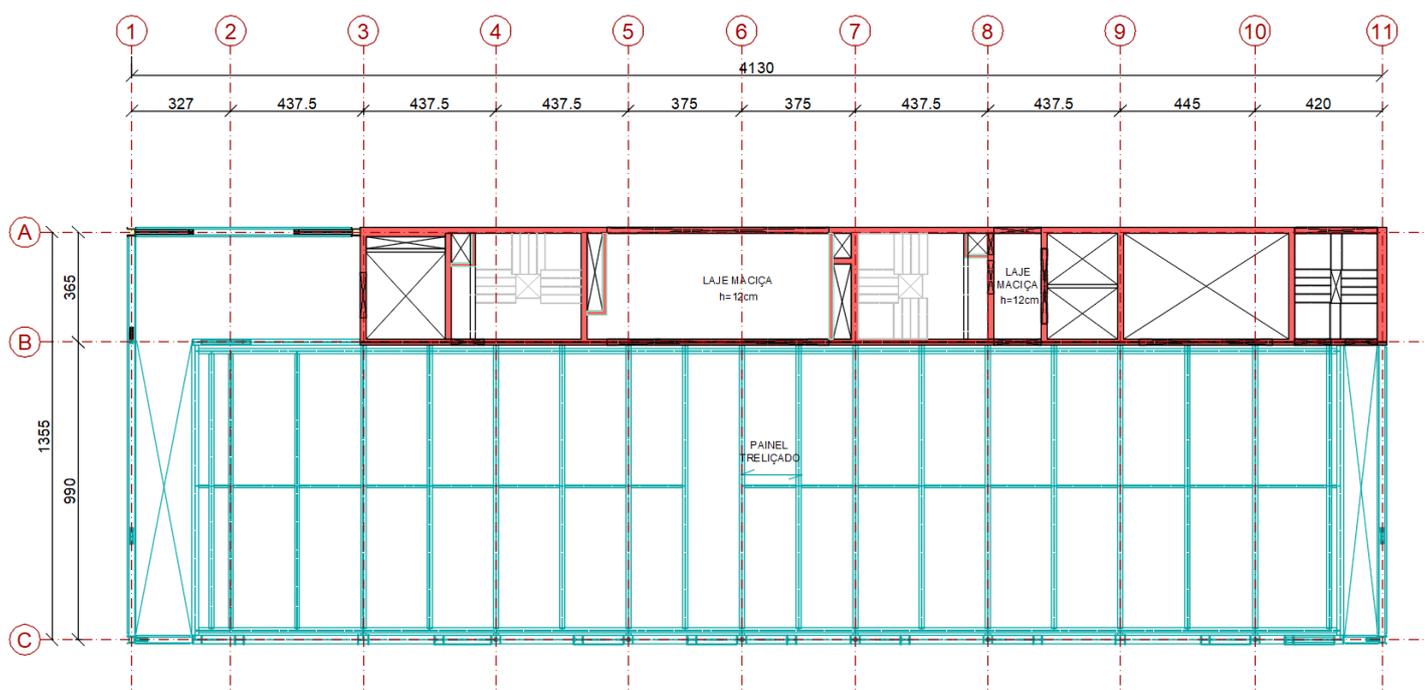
Planta de Arquitetura – Oitavo pavimento: exposição permanente
